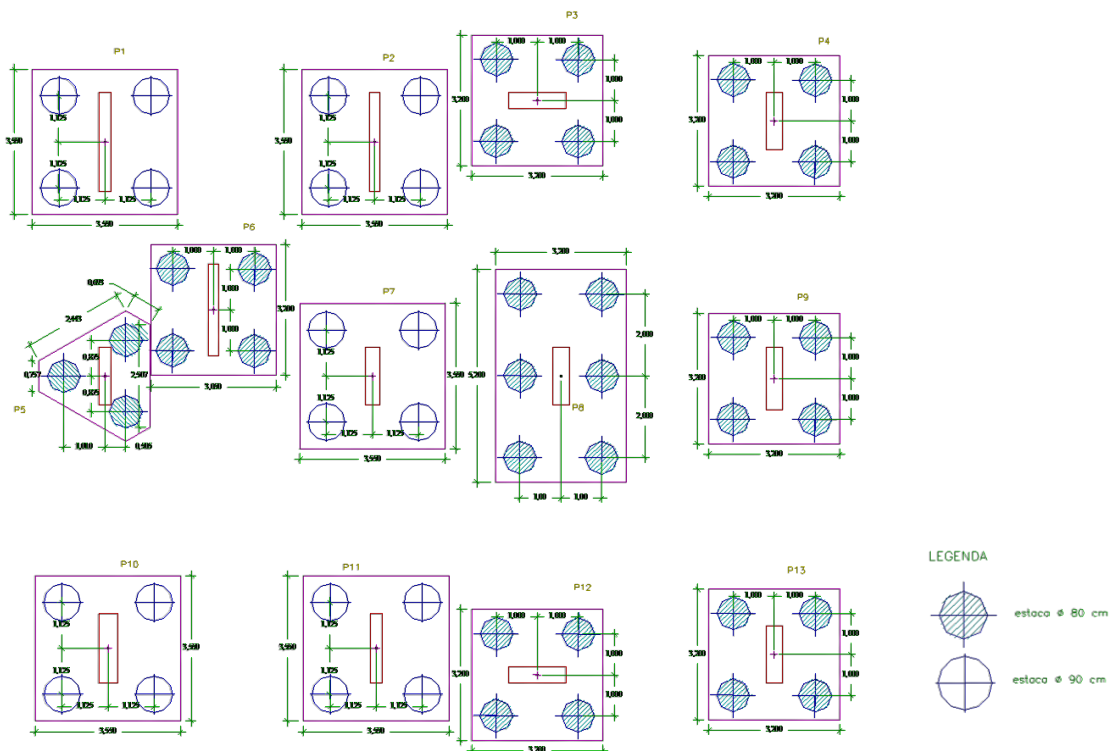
Planta de fundação (Estaqueamento) – Edifício 3
